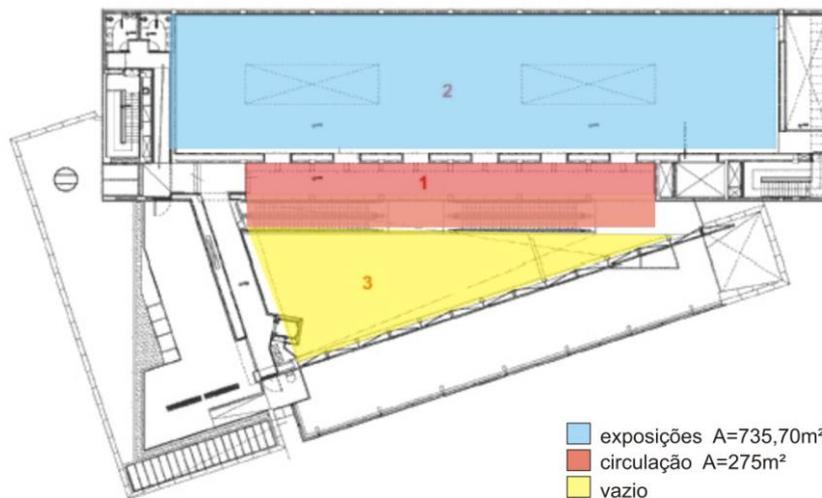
Planta Baixa Pavimento Térreo (ARCOWEB,2010)
